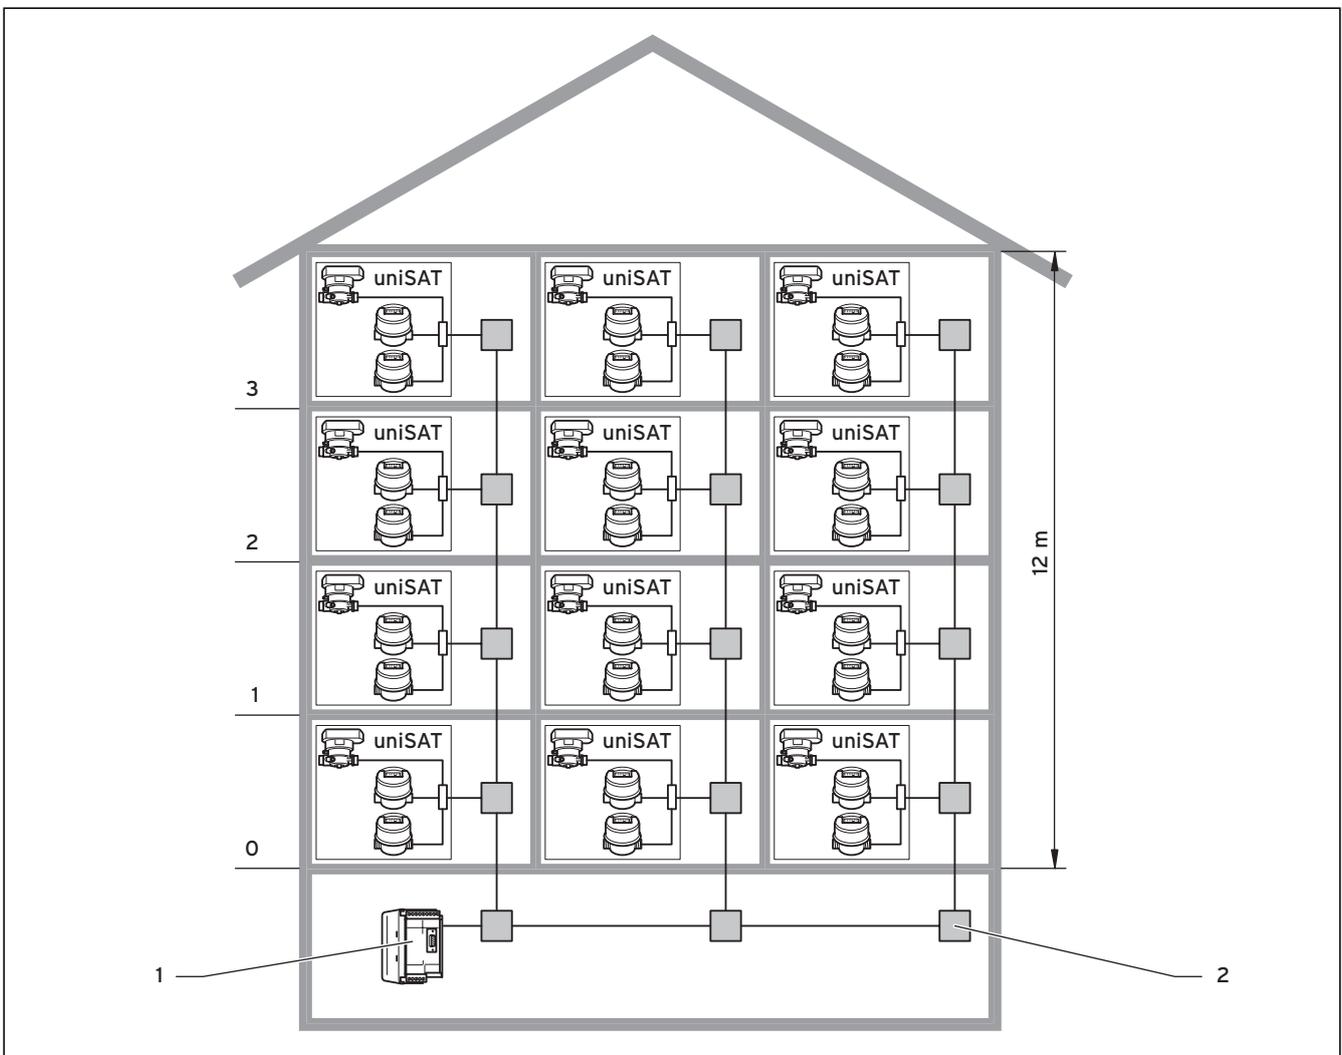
Installazione bus M: condotto cavi a fascio
